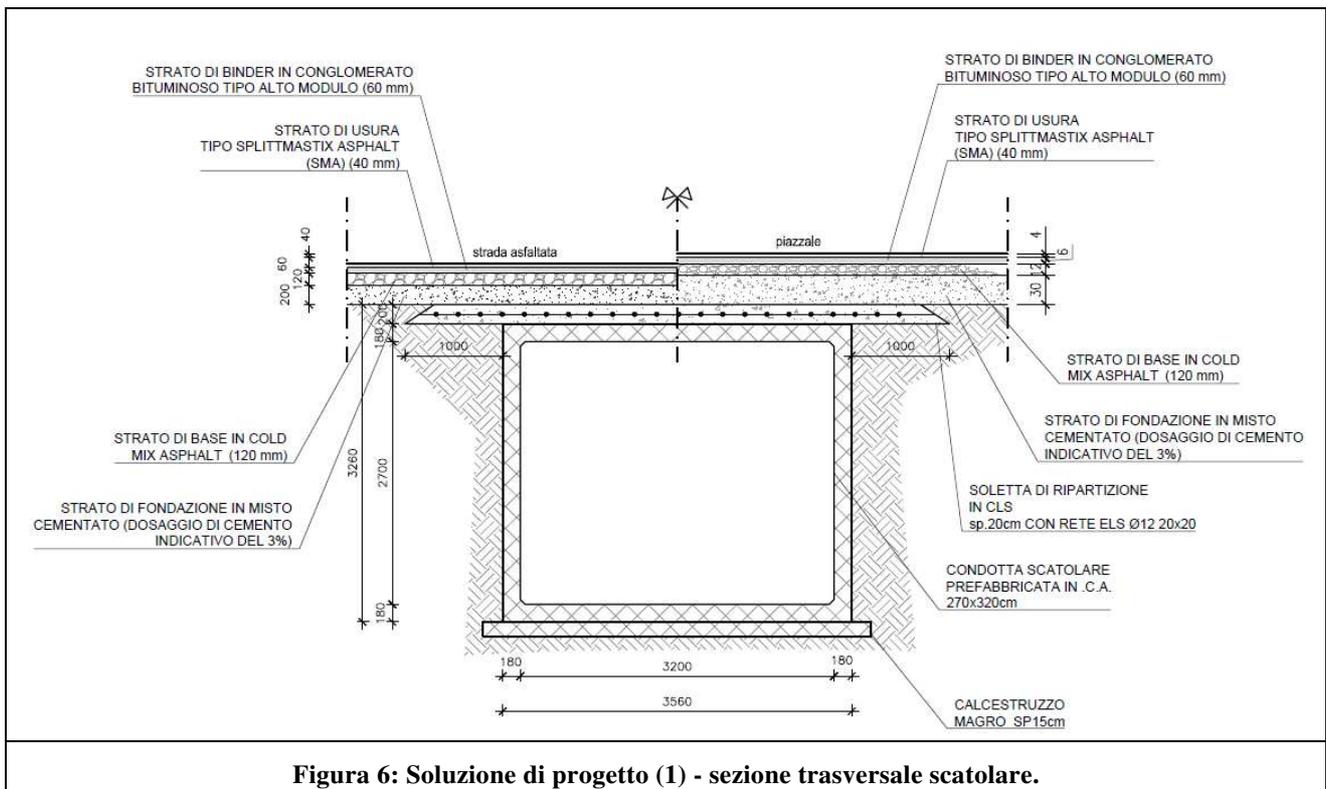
Soluzione di progetto (1) - sezione trasversale scatolare.
